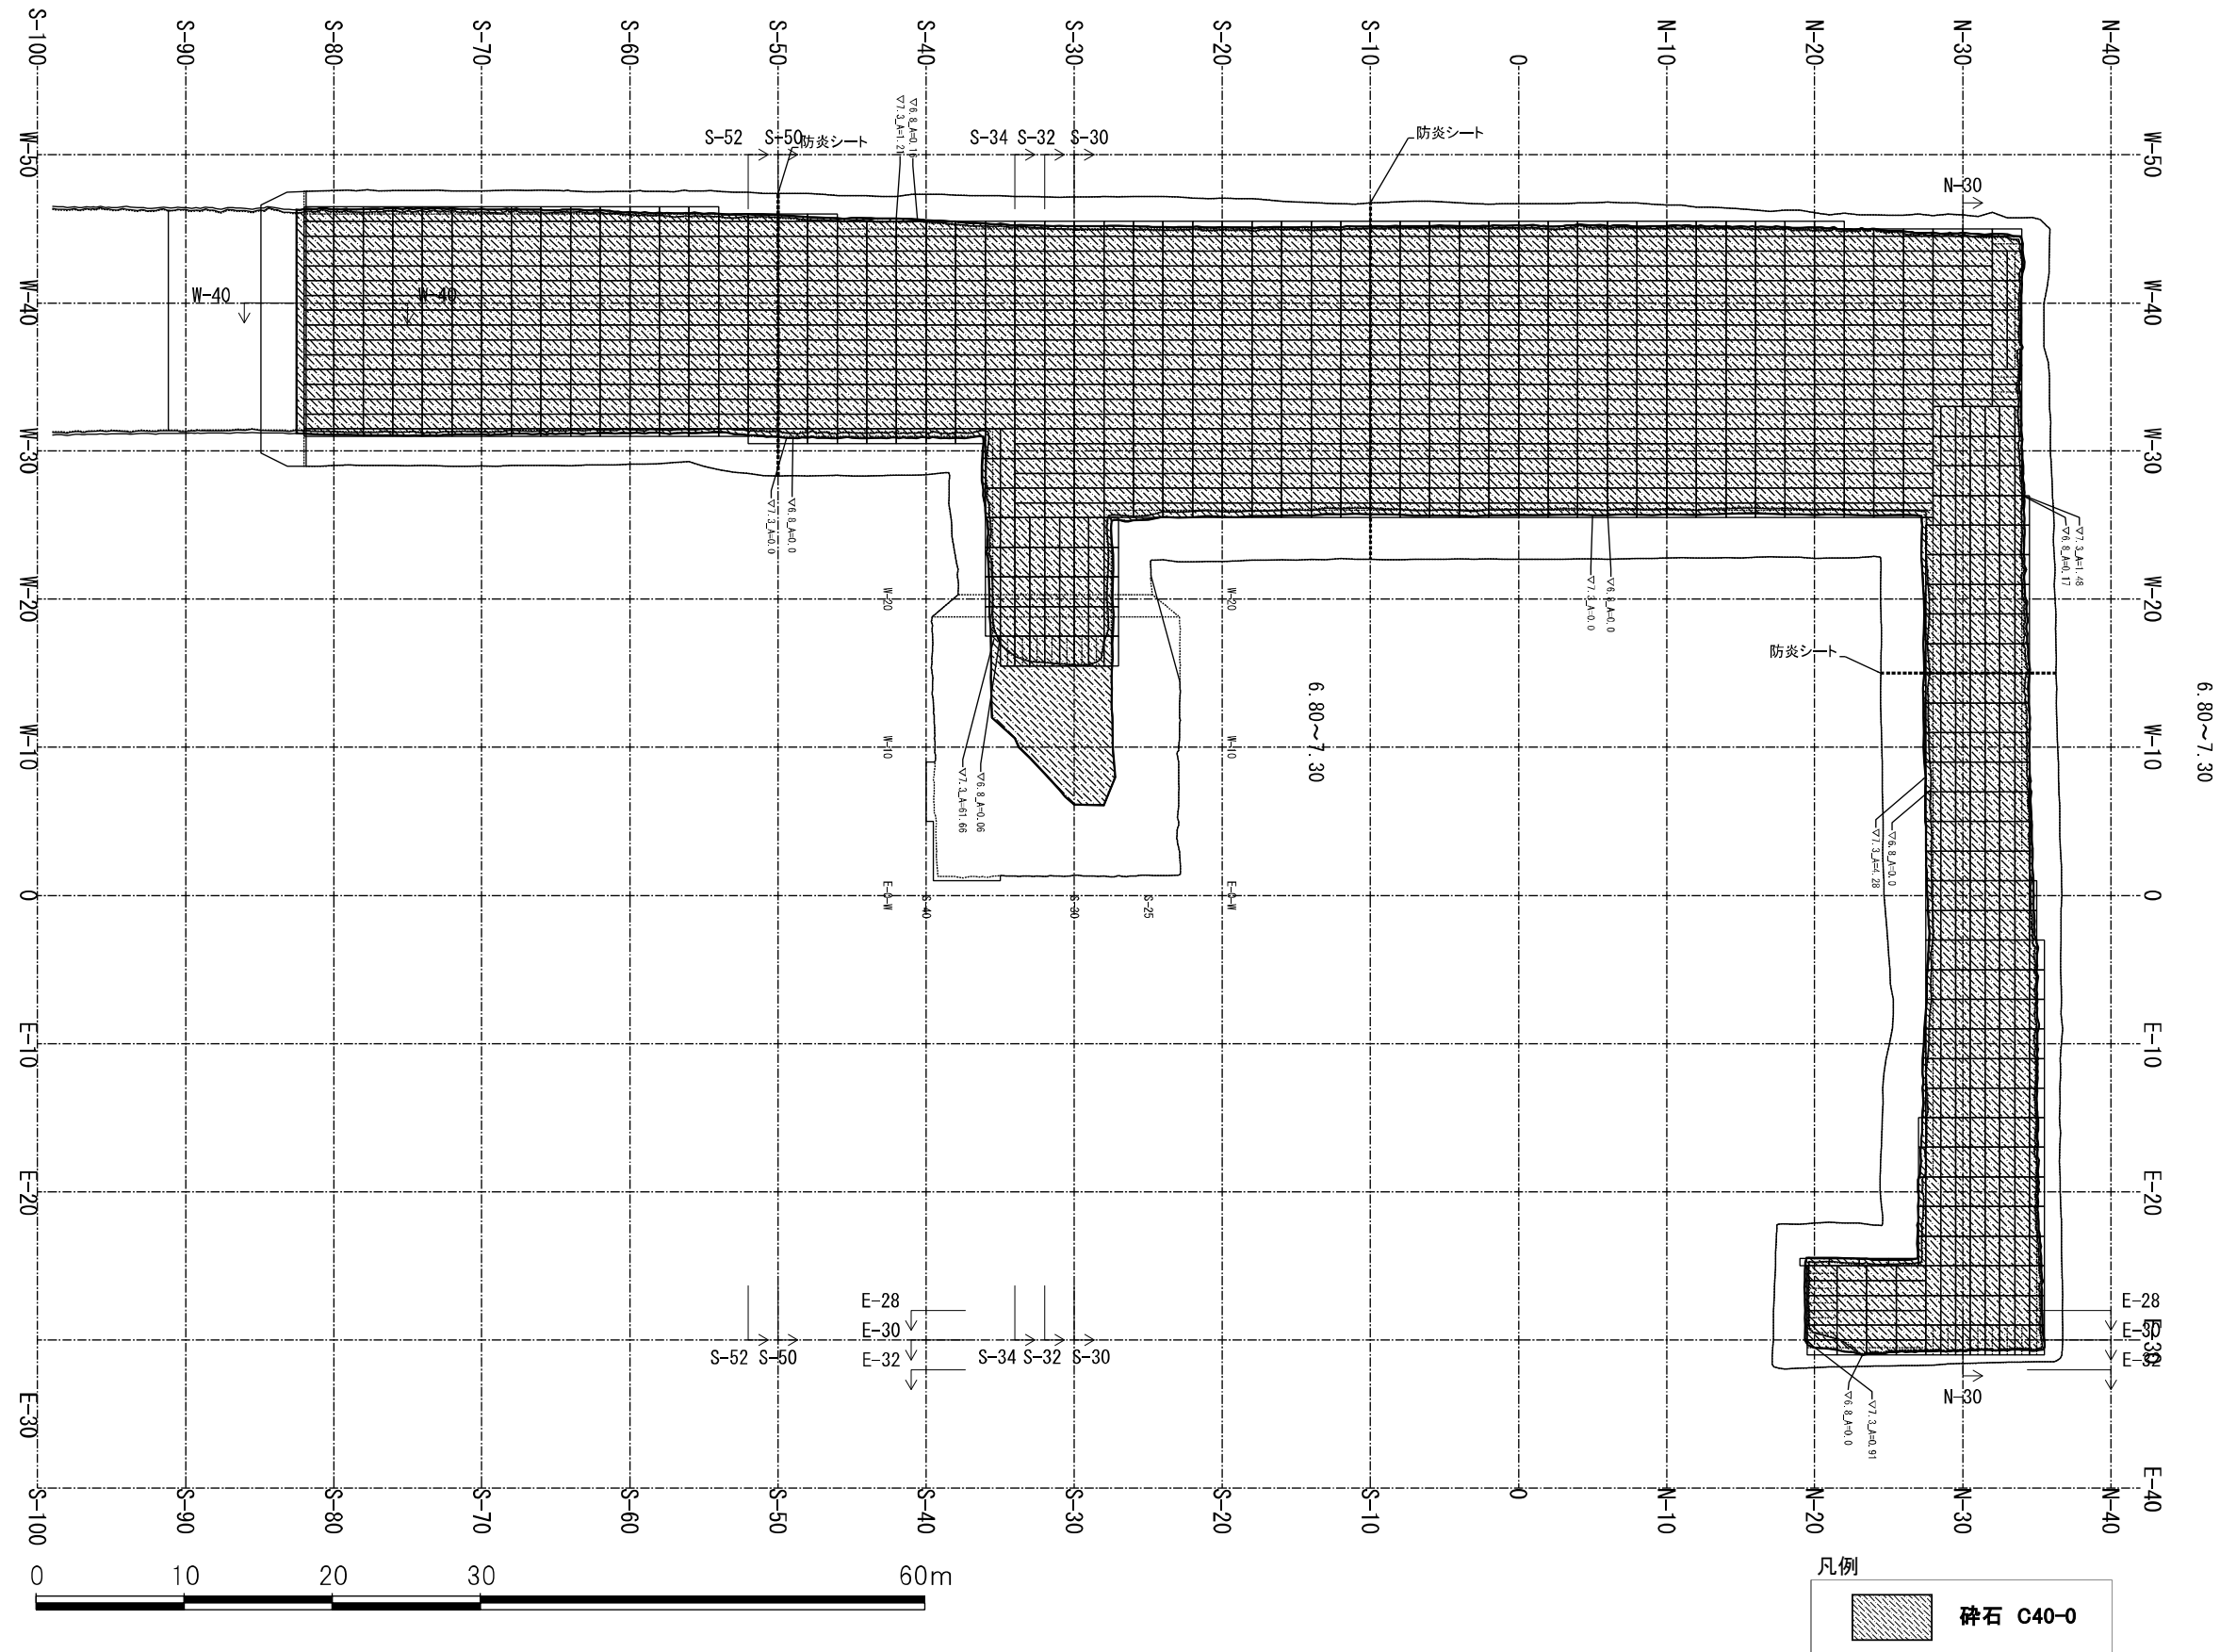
内堀保護工 平面図(TP+6.80~+7.30)
